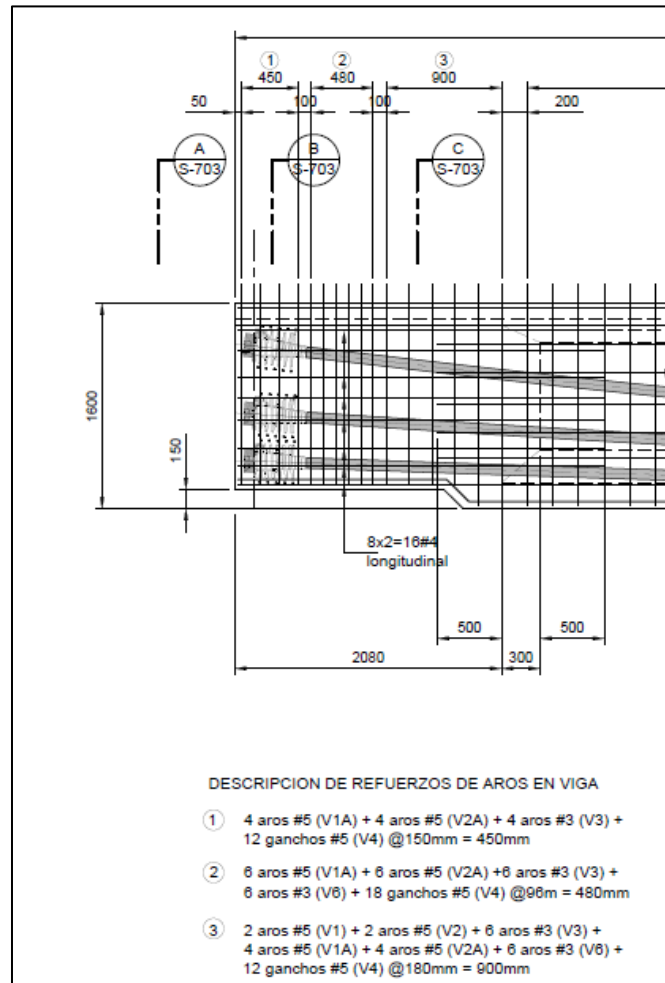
Indicación en planos de la zona n.º 3 de refuerzo transversal en vigas de superestructura n.º 5
